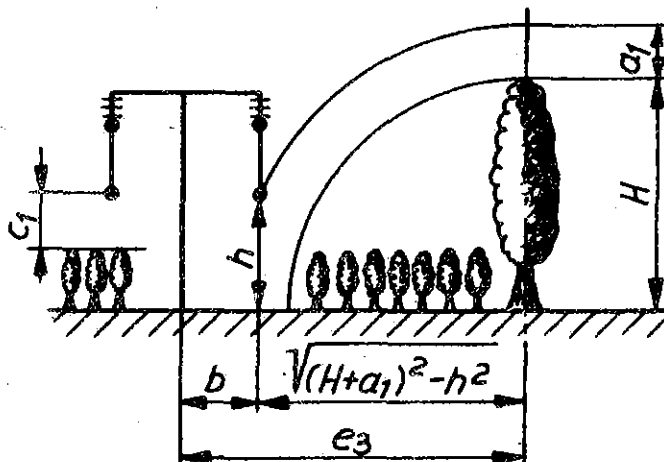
Mindestabstand zu einzeln stehenden Bäumen
